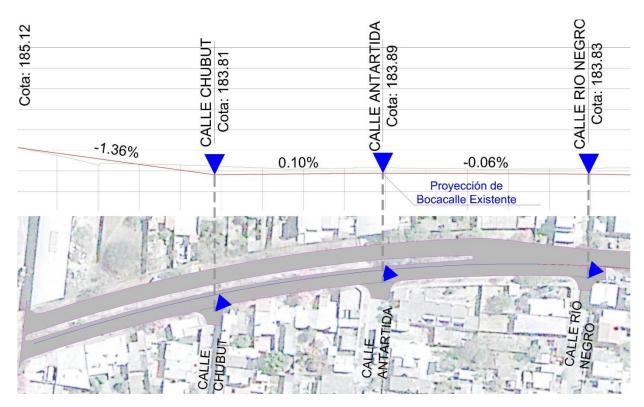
Planialtimetría donde se muestra la proyección de calles perpendiculares.
